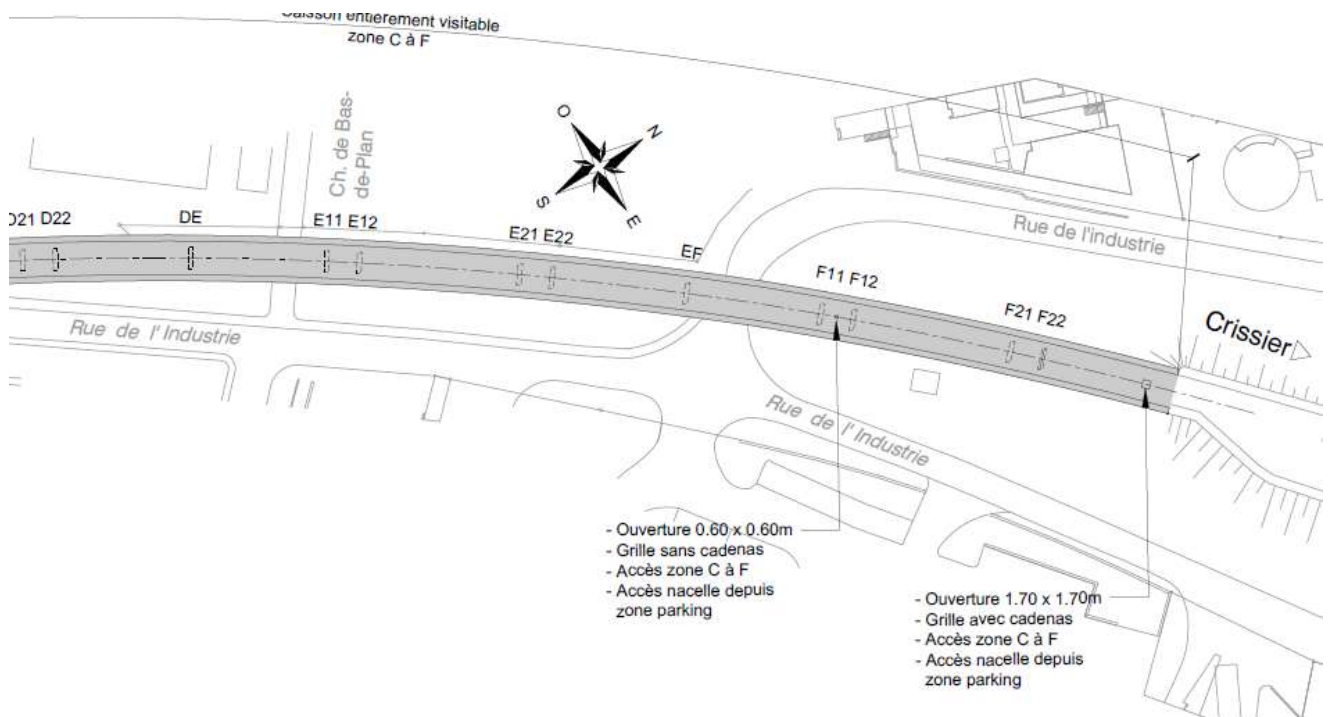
Accessibilité du caisson des piles D21/22 à la culée Crissier
